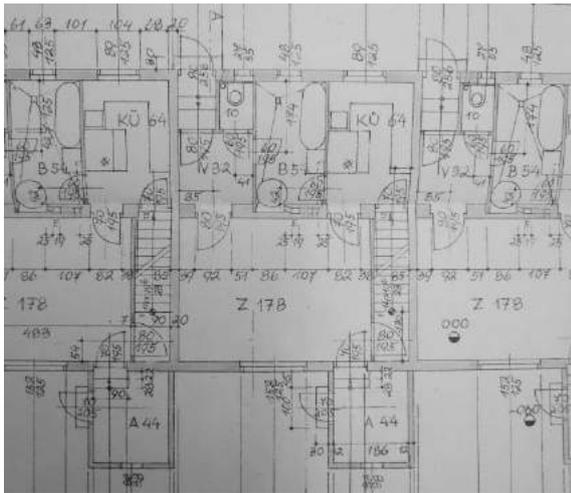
Einfamilienhaustyp Erdgeschoss -Stephan Simony
